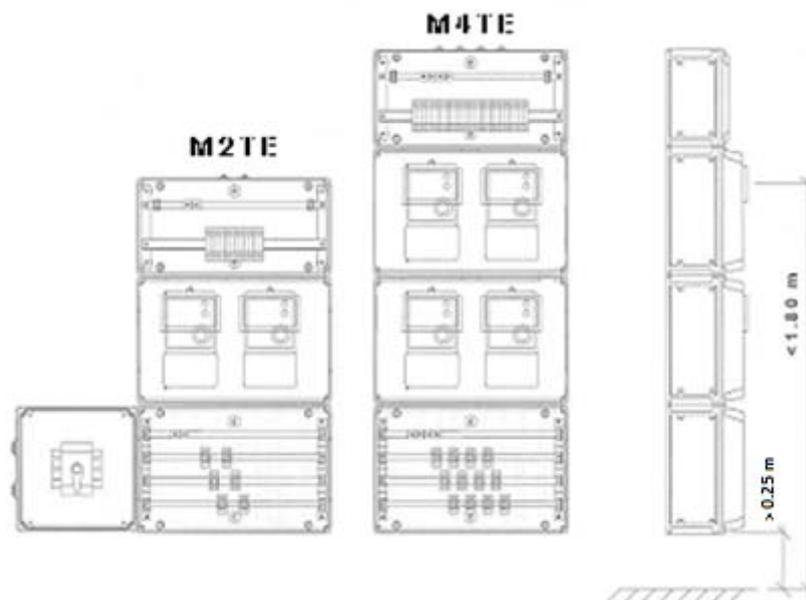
Cuadro modular tipo EM (con envolvente). Mirillas practicables TR – 16
